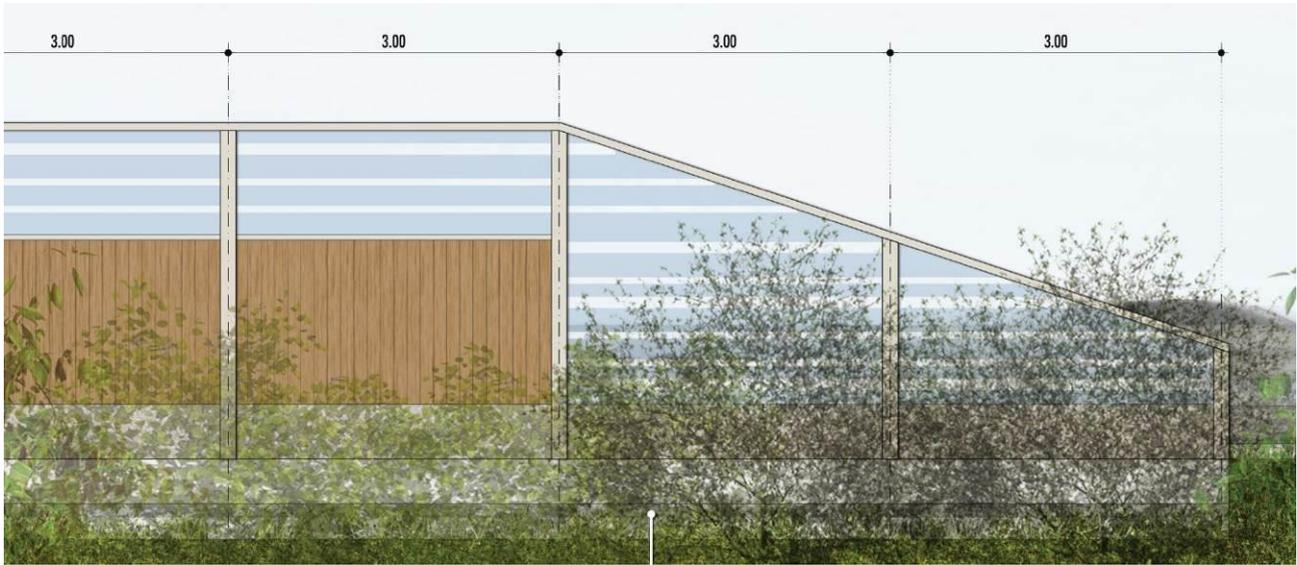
TIPOLOGICO DELLA TRANSIZIONE DI INIZIO/FINE BARRIERA - PROSPETTO SU RILEVATO, LATO RICETTORE
